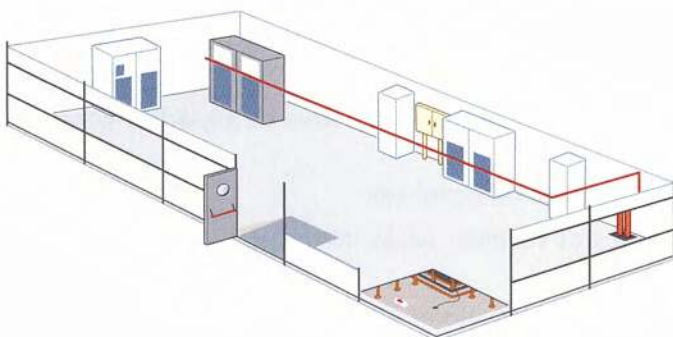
Vista general de un diseño de instalación de cableado con suelo técnico elevado. La entrada de cables a los cuadros y armarios se realiza por la parte inferior.
